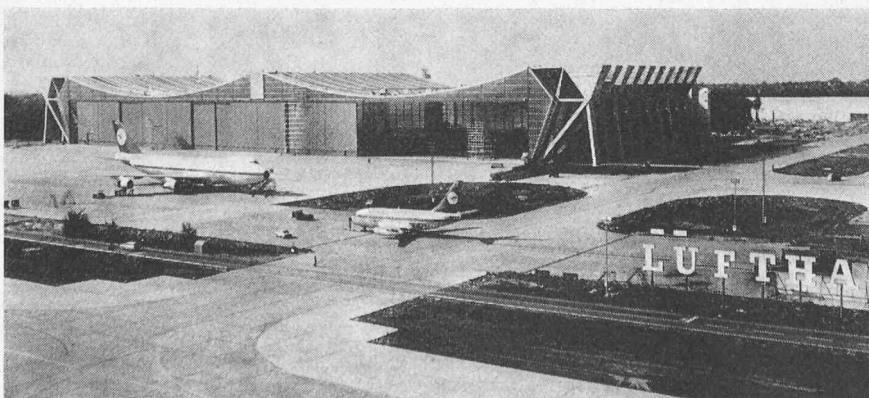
Wartungshalle V, Frankfurt, zweischiffiges erdverankertes Hängedach aus Spannleitchbeton mit 2×130 m Spannweite. Grundfläche: 270×100 m, lichte Höhe: 22 m, Torlänge: 270 m
